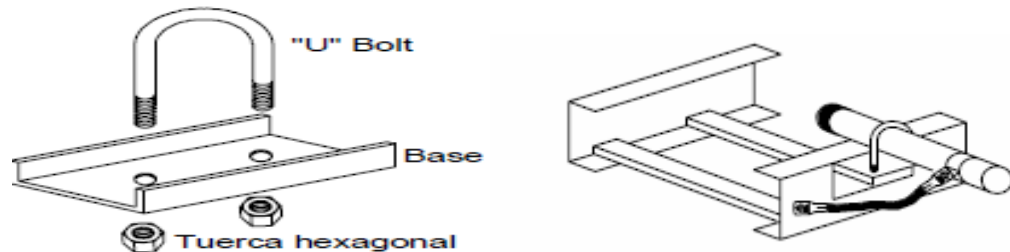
Soporte para tubo conduit y con puente para tierra
